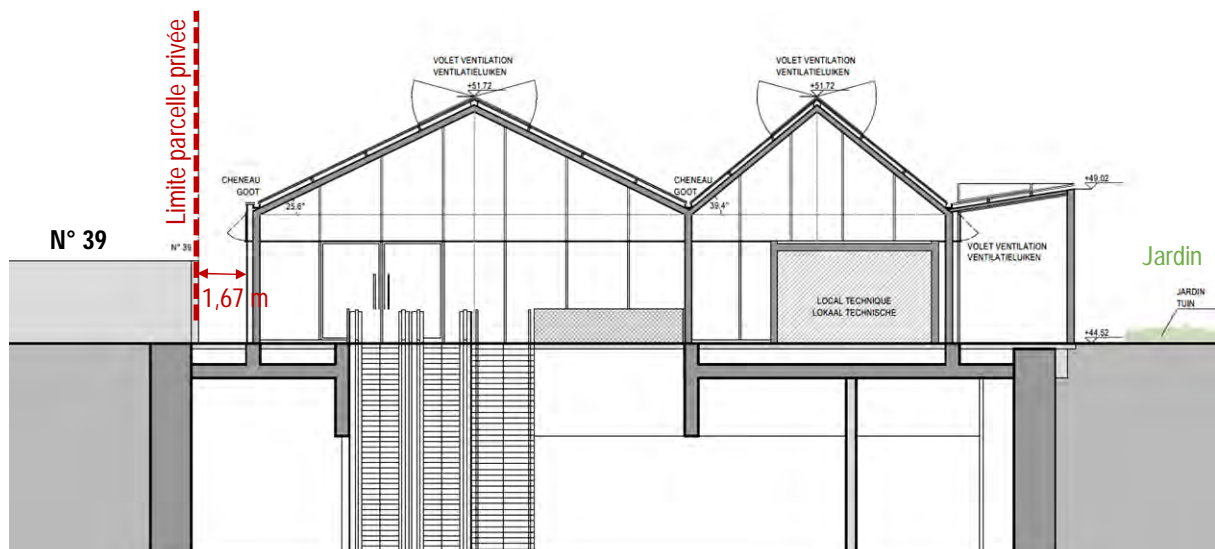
Coupe transversale (ARIES sur fond BMN, 2017)
